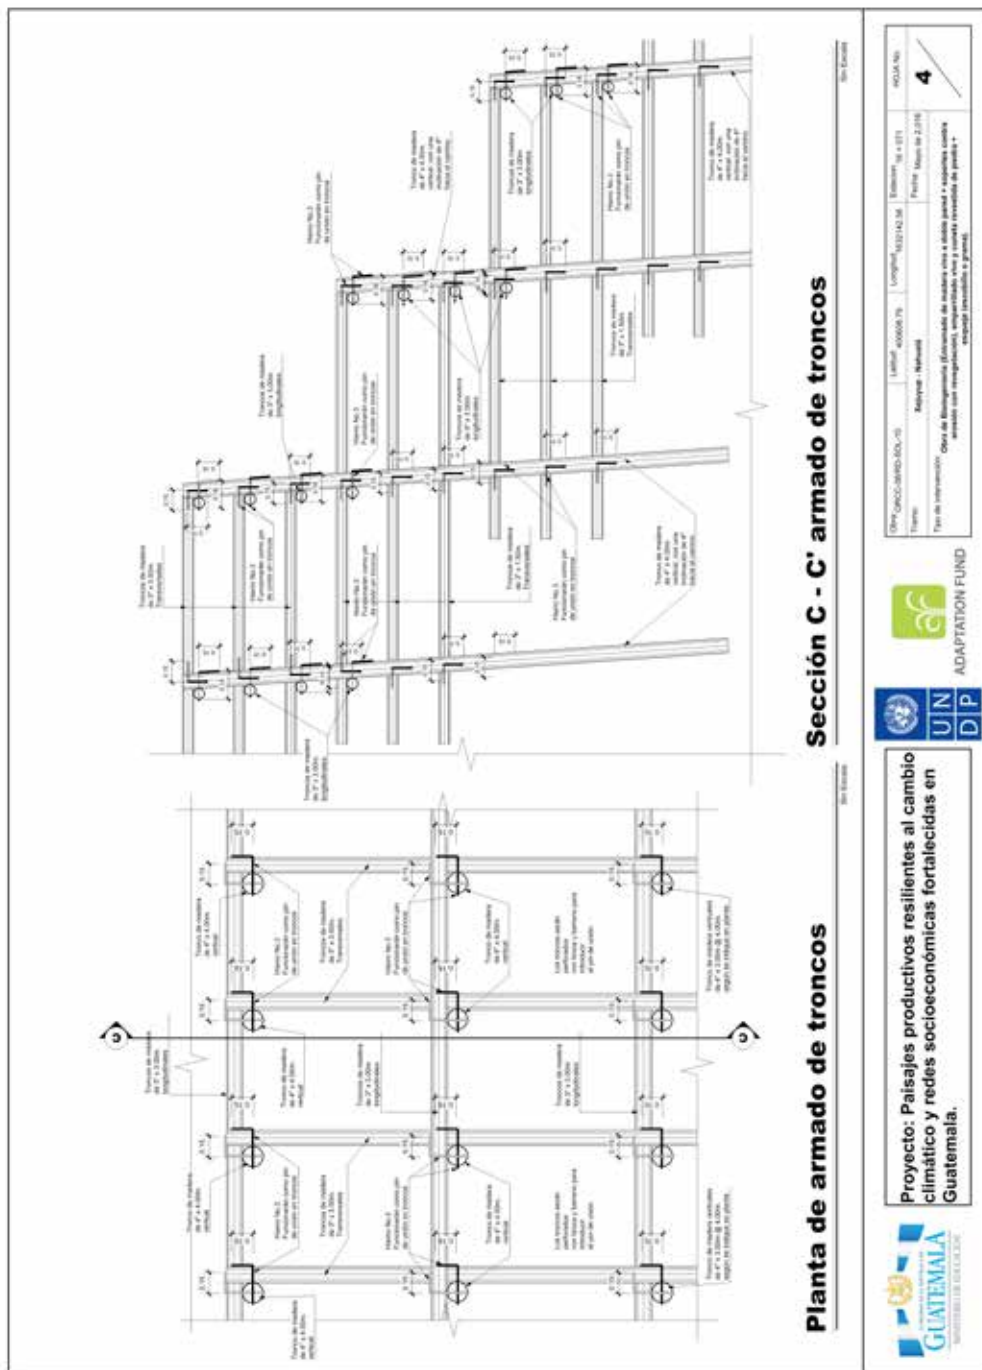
A. PLANTA DE ARMADO. SECCIÓN C-C. Planificación Obra ORCC-06/IRD-SOL-10. Tramo: (CA-01 Occidente/ KM-171-Xejuyup, Nahualá)
